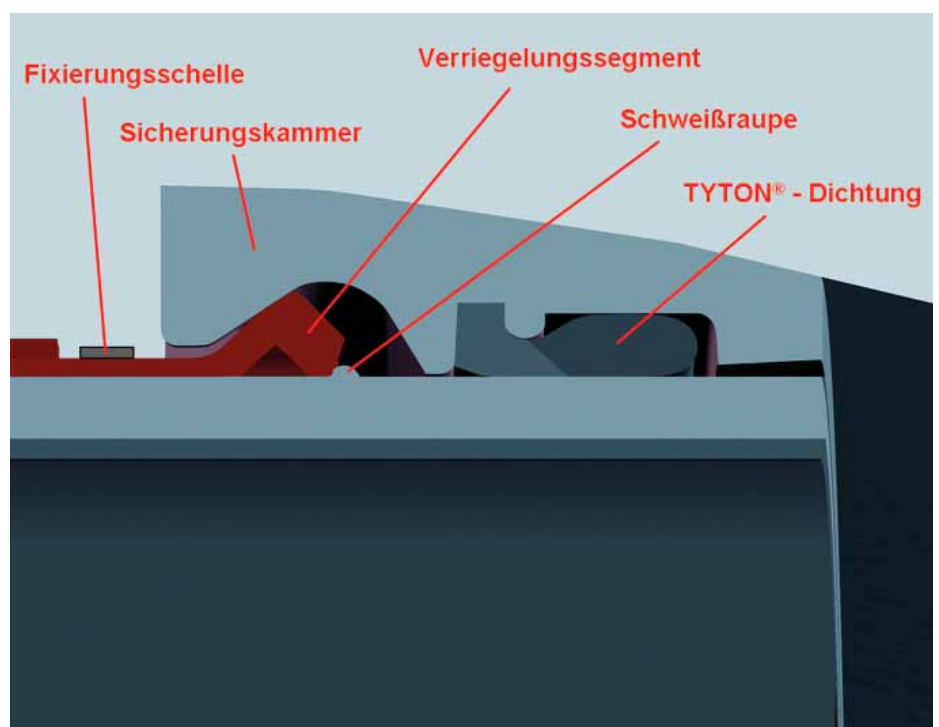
Aufbau der BLS/VRS-T Verbindung DN 900 mit Fixierungsschelle für grabenlosen Einbau
